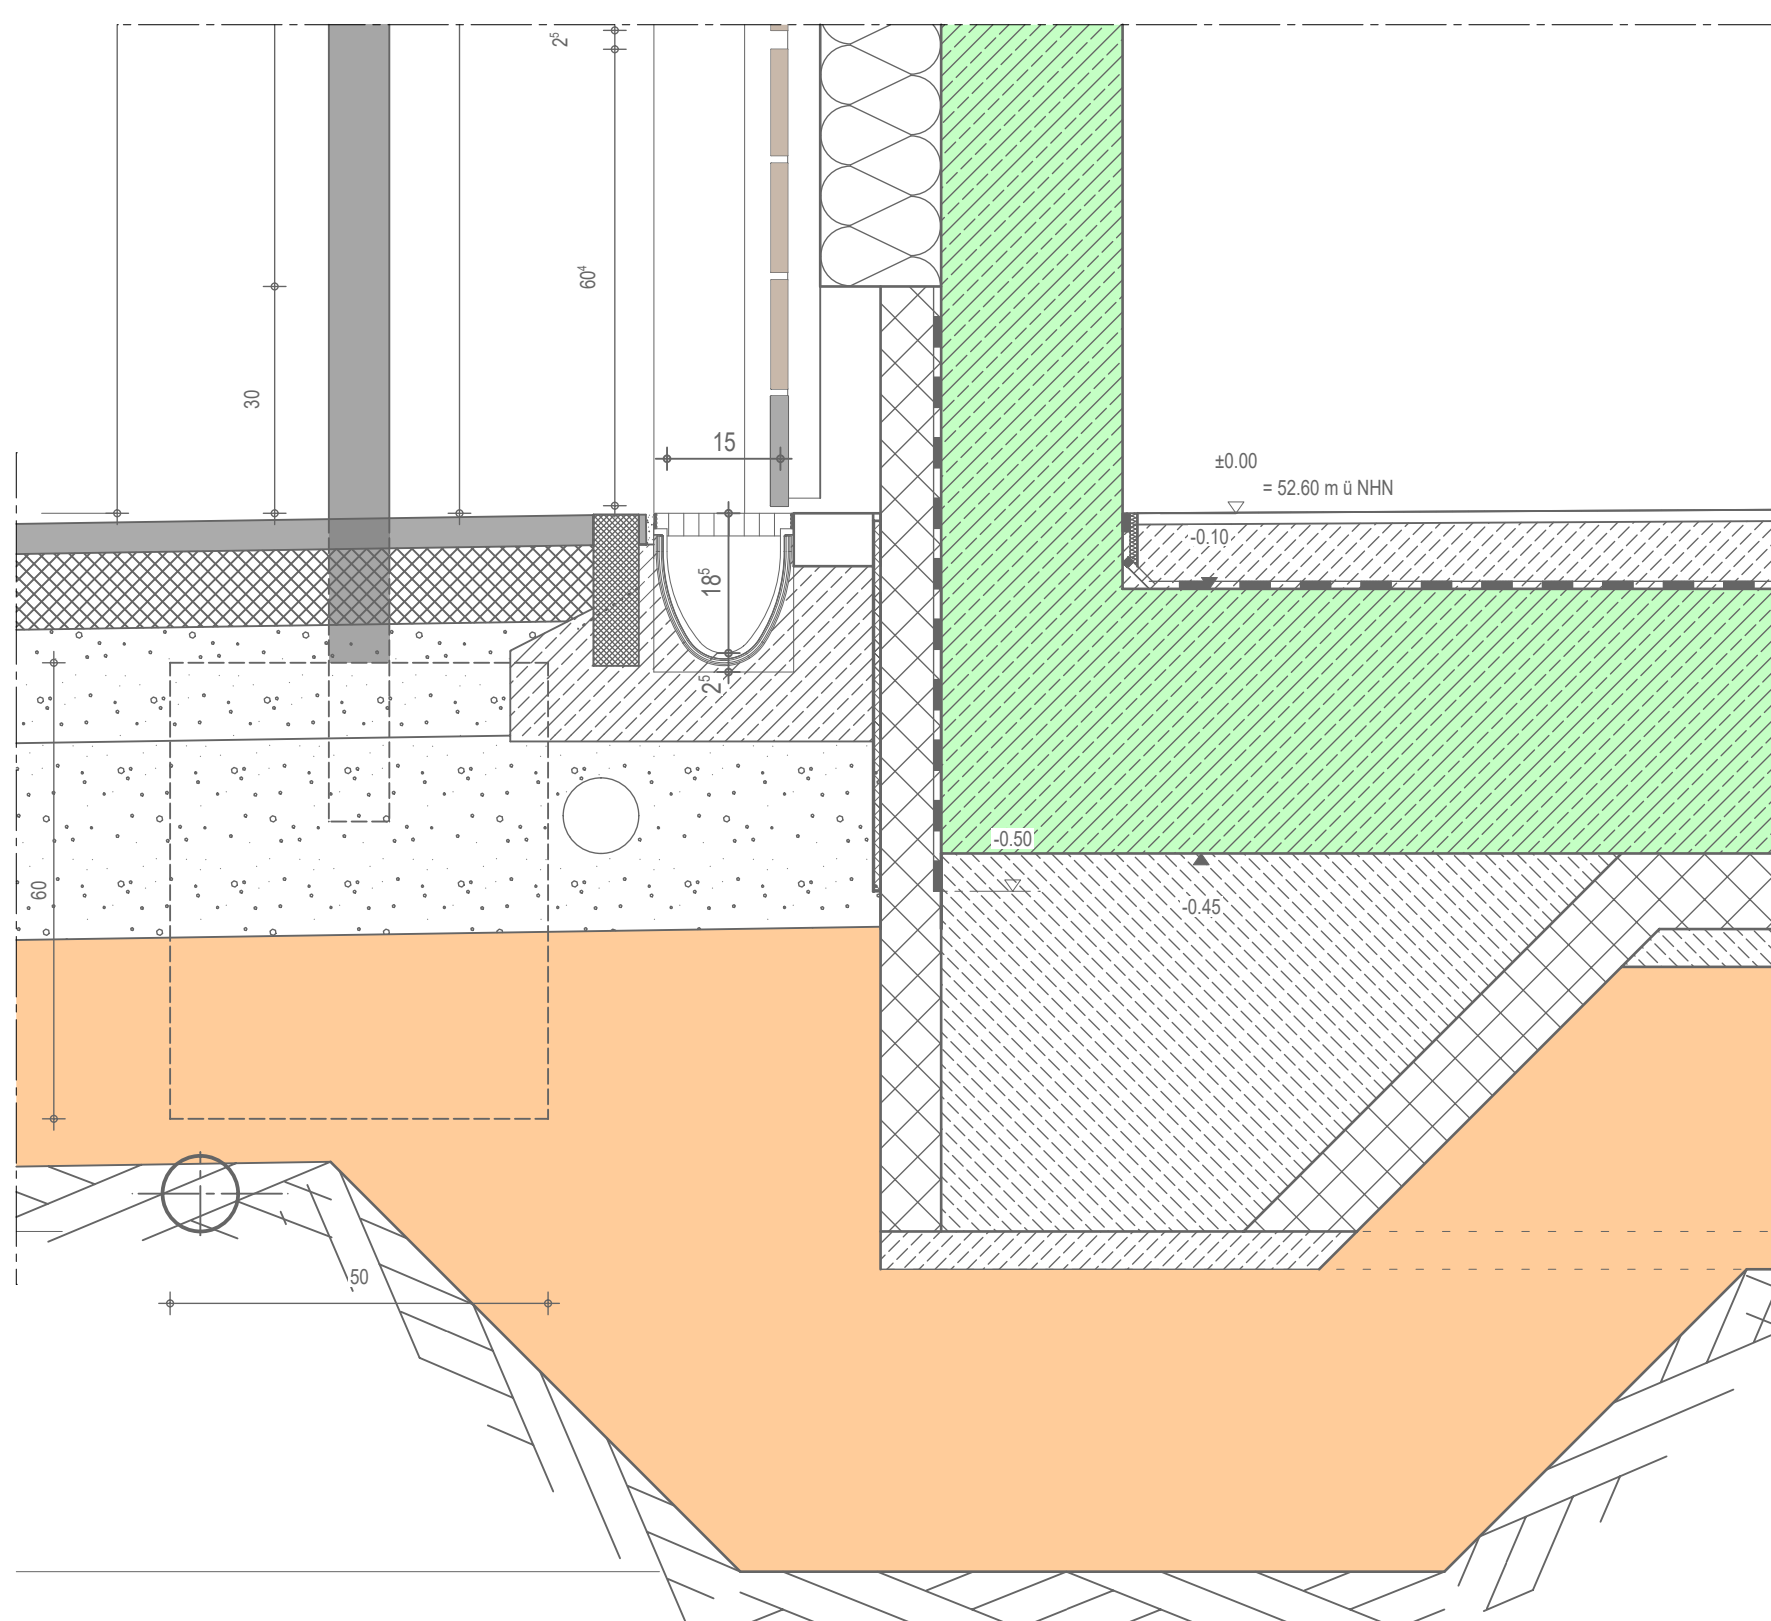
/ AUSSCHNITT GRUNDRISS EG M: 1/5
